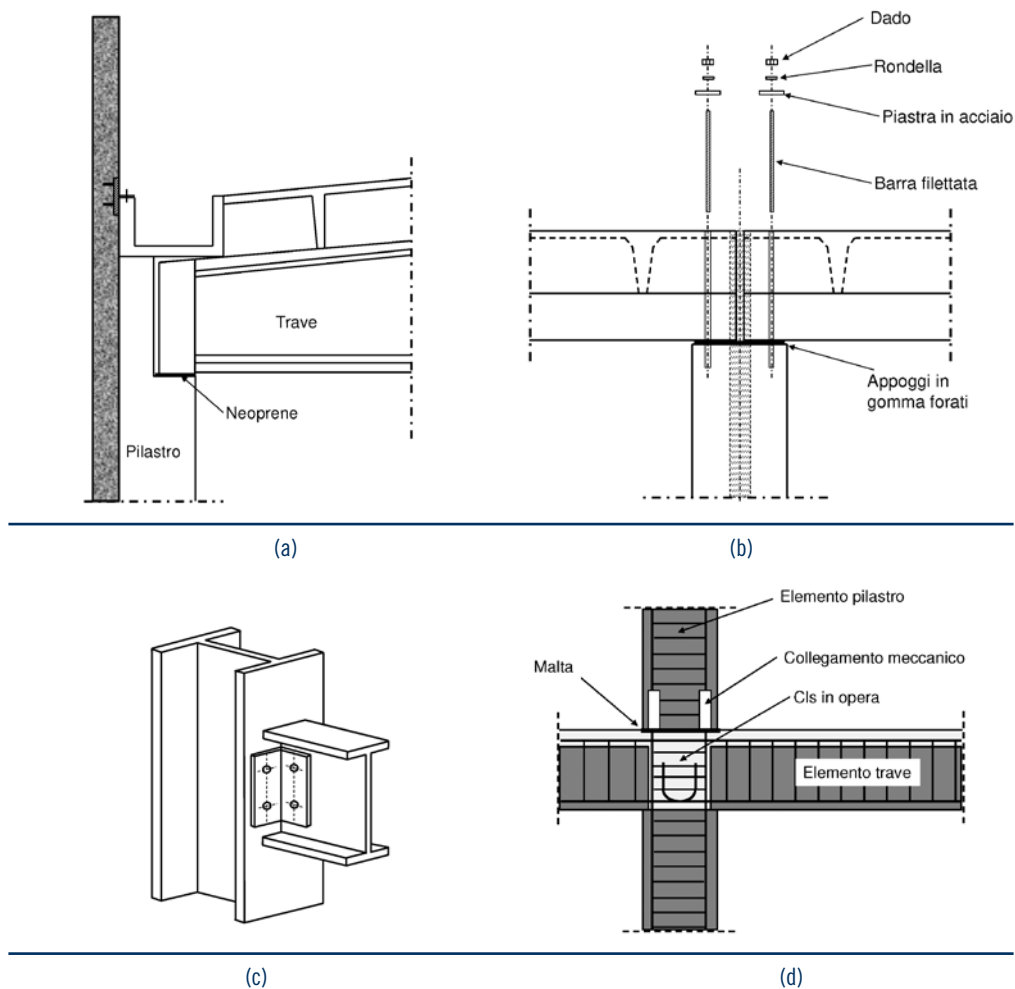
Connessione trave - pilastro/parete: a) appoggio, b) cerniera, c) semi-incastro, d) incastro.
